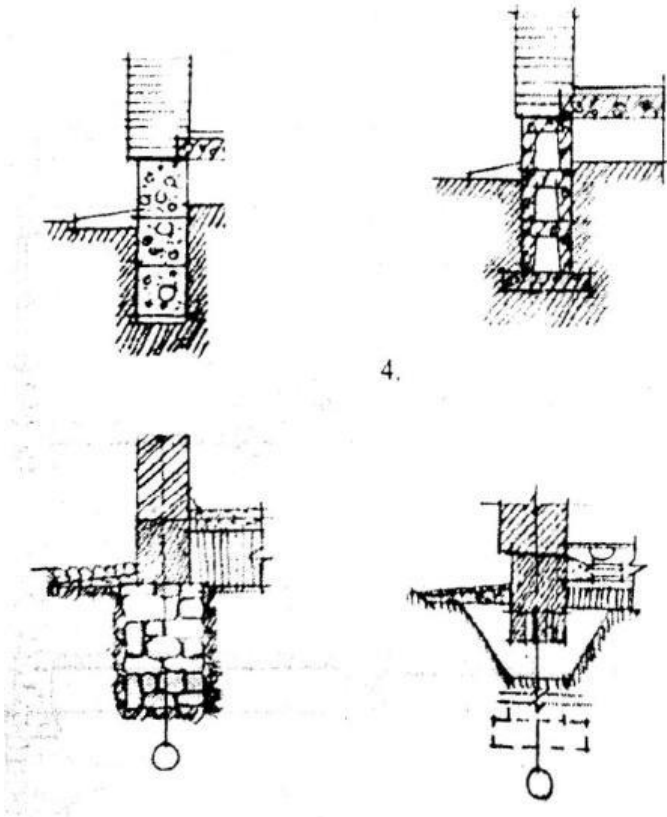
Вирішення перекриття фундаментів із перекриттям підвальних поверхів: 1 - із суцільних залізобетонних блоків, 2 - з пористих залізобетонних блоків; 3 - фундамент бутовий, 4 - стовпчастий
